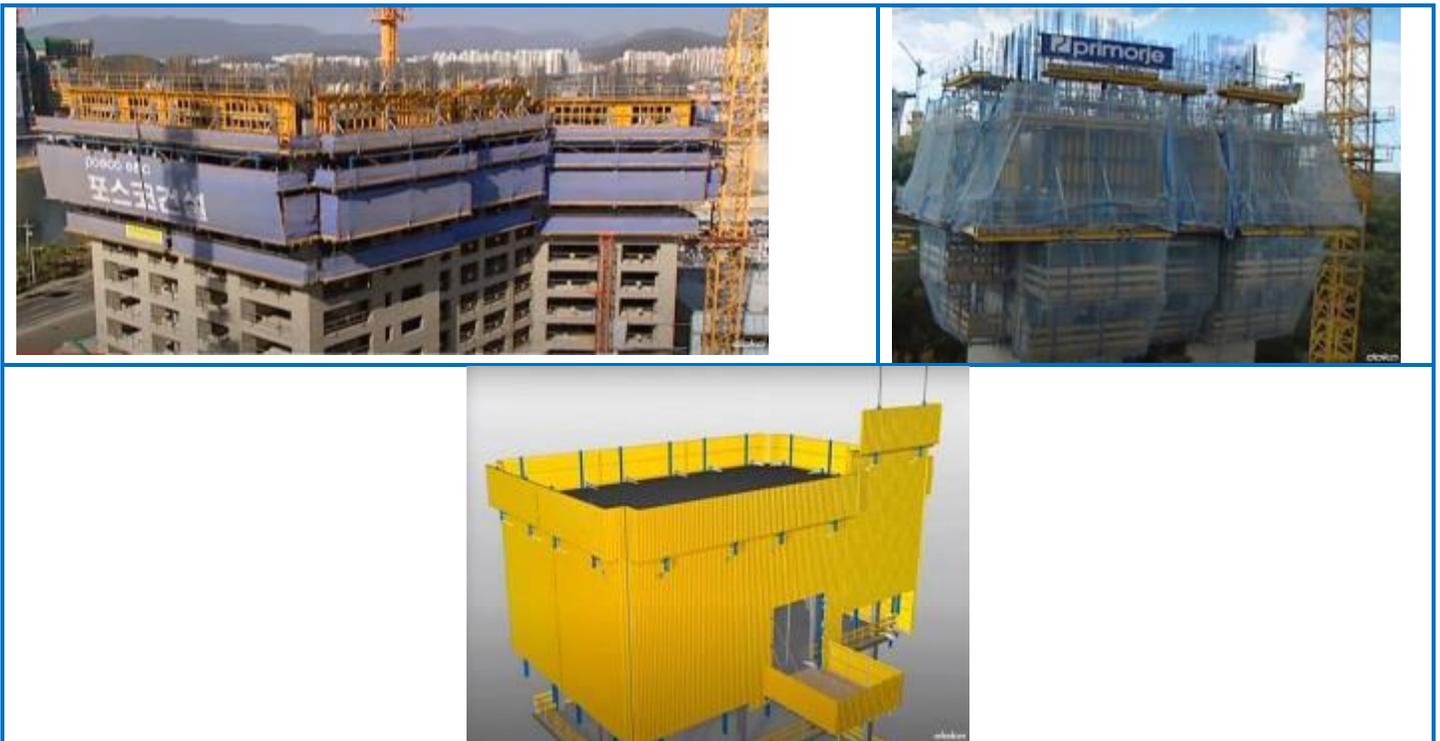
encofrado trepante de protección a las que se anexan redes - Fuente: Doka Climbing Systems
